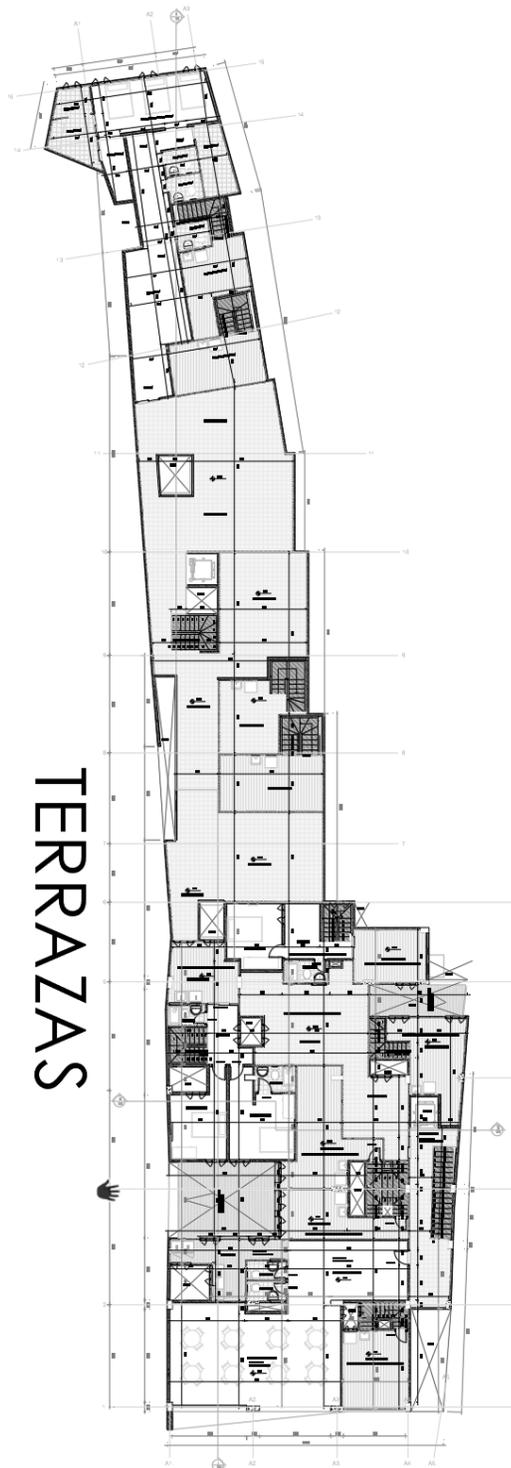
Planta arquitectónica nivel 2, 4, 6.
